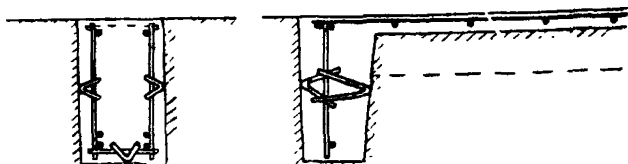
Упоры для обеспечения проектного положения арматурных каркасов в форме (опалубке)
